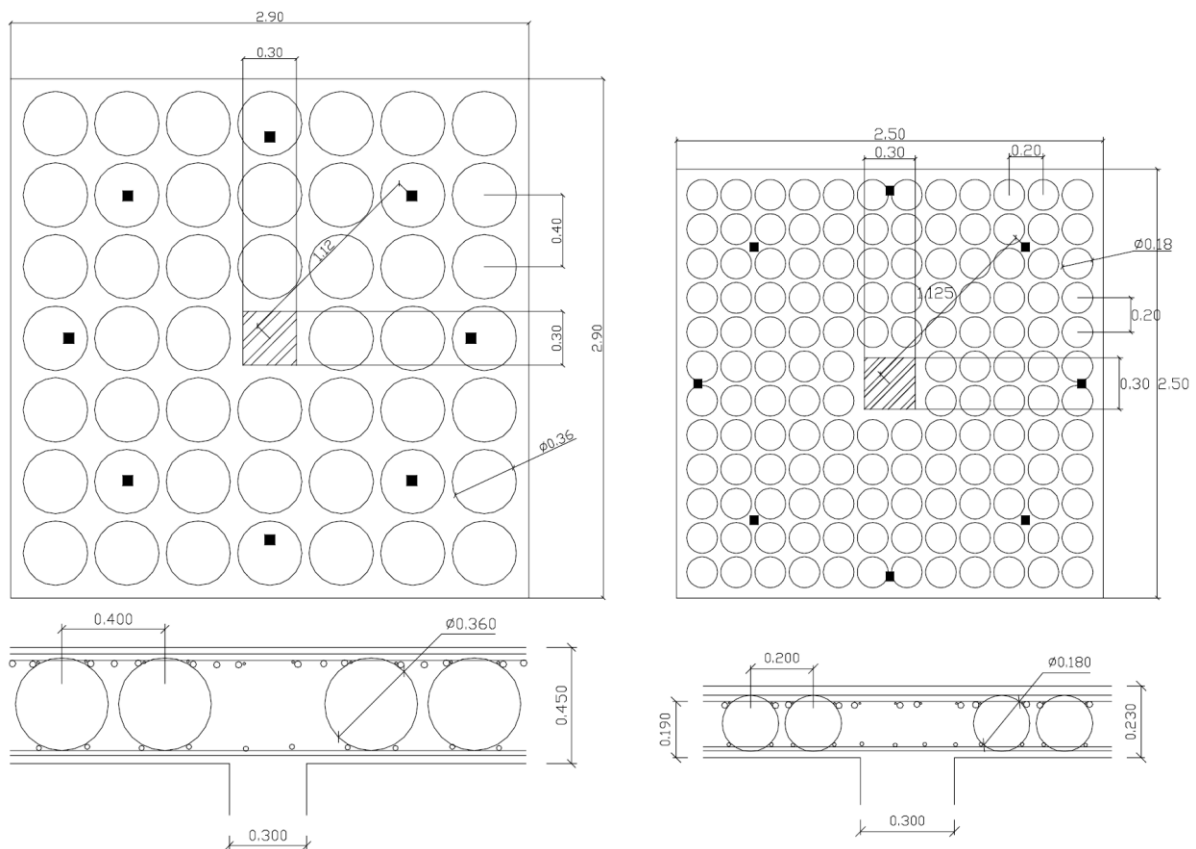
Vistas superior e corte dos painéis de laje ensaiados por HELD (2002)
